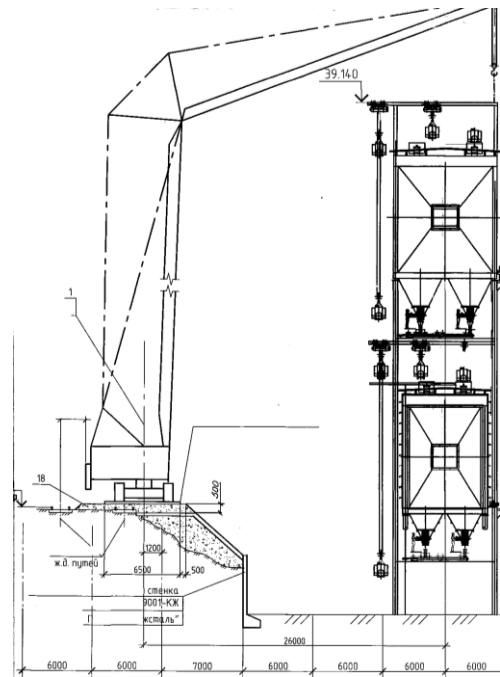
Монтаж верхнего электрофильтра ЭФ-1 и его оборудования краном СКГ-63/100
